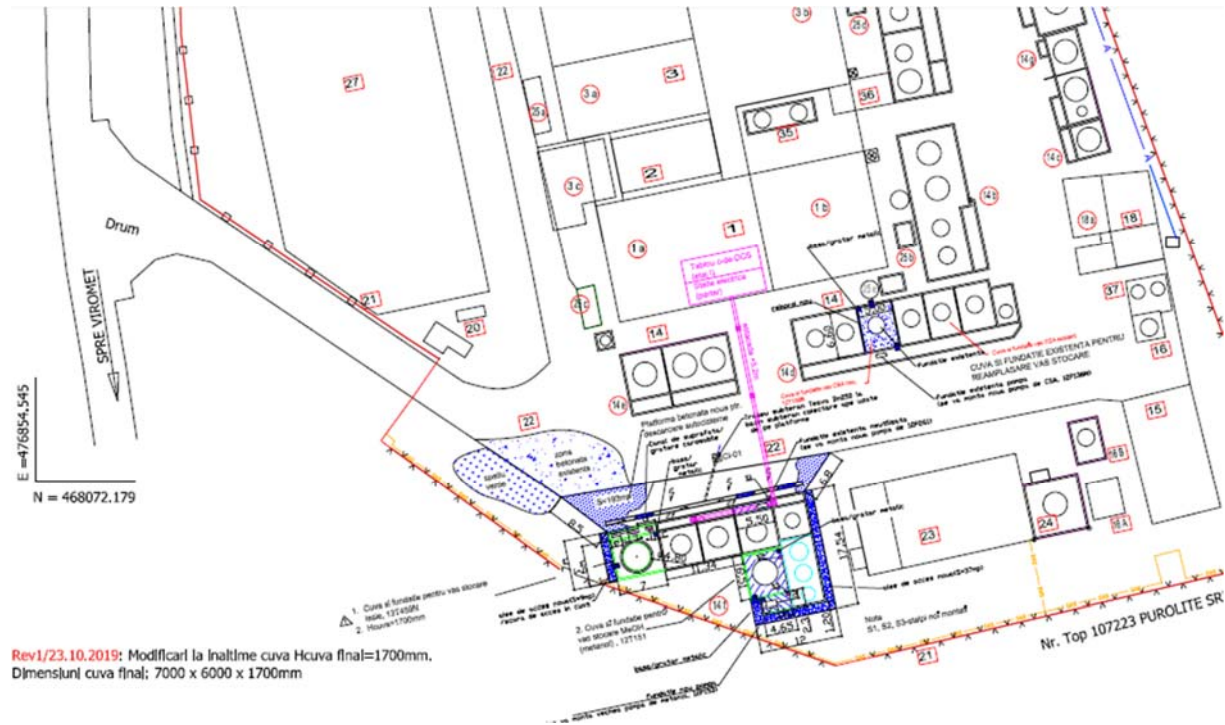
Plan de situatie cu amplasarea noilor rezervoare
